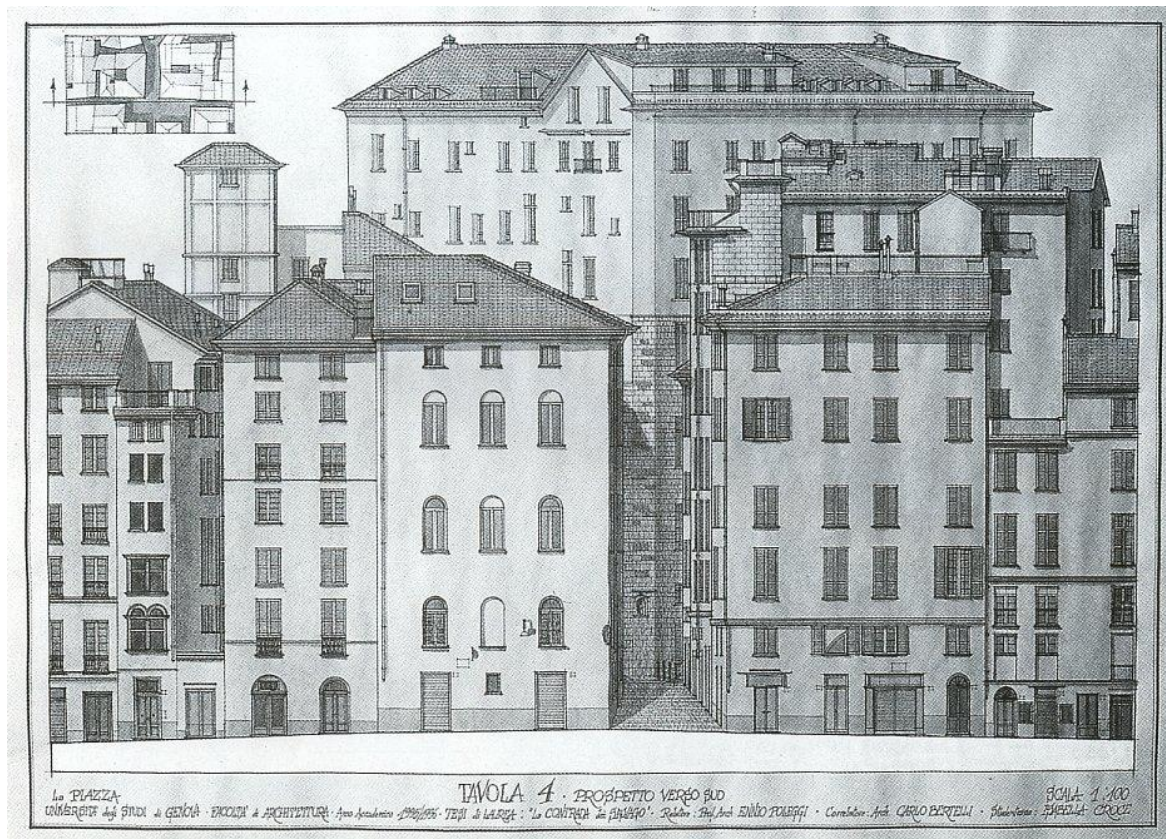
Prospetto della Piazza dei Salvago (attuale Piazza S. Bernardo), verso Vico Vegetti. Il palazzo a destra era l'antica loggia, mentre quello retrostante era la sede dell'Albergo Salvago nel 1637 e l'oggetto della ristrutturazione del Bianco.
